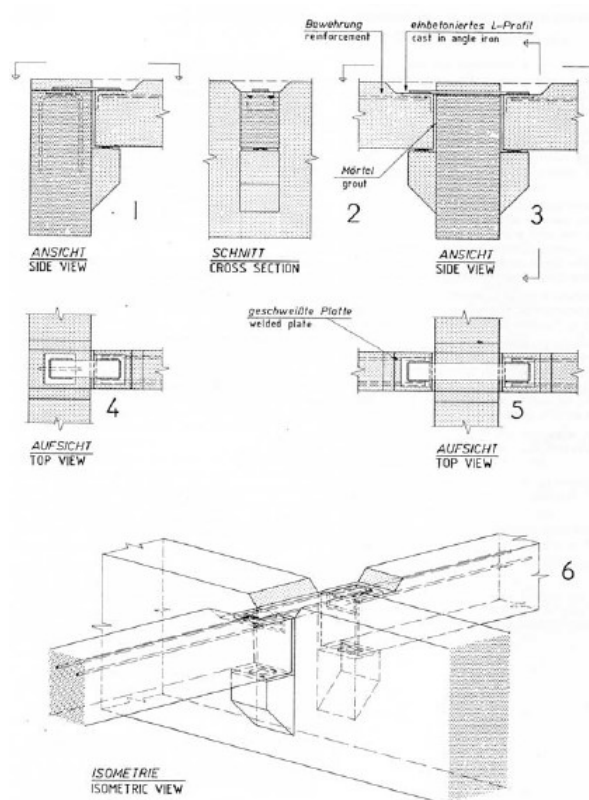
Ligação por consolo de betão e chapas soldadas (Stupré, 1981)
